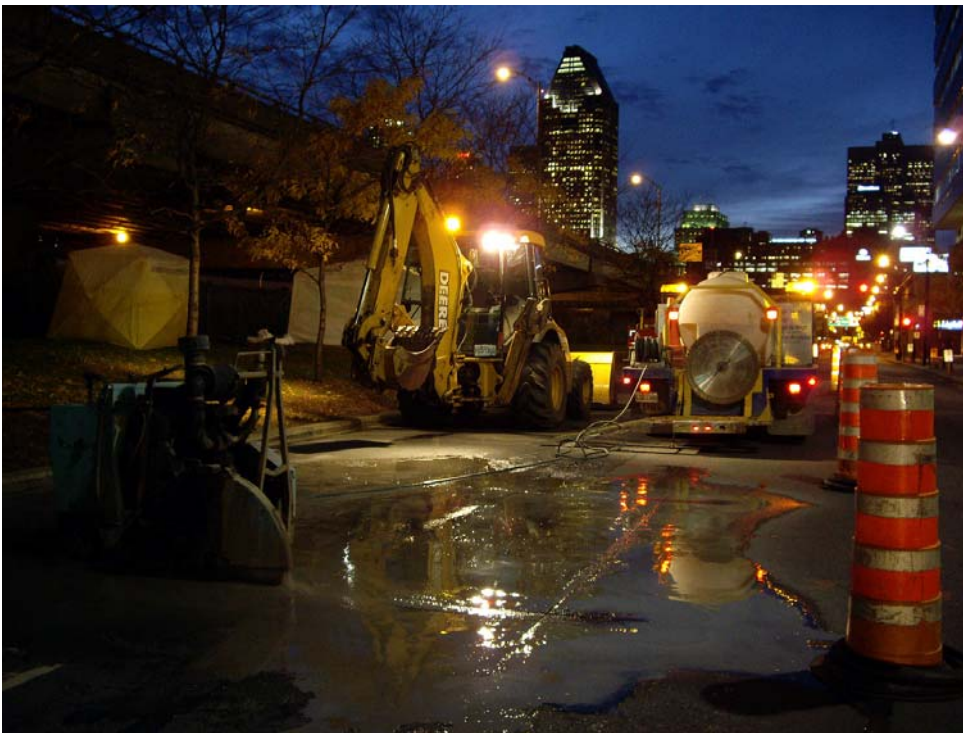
Travaux d'un tranchée de fouilles archéologiques le soir (07E142-43 et 44) sur la rue Duke, entre les rues Wellington et Ottawa.
